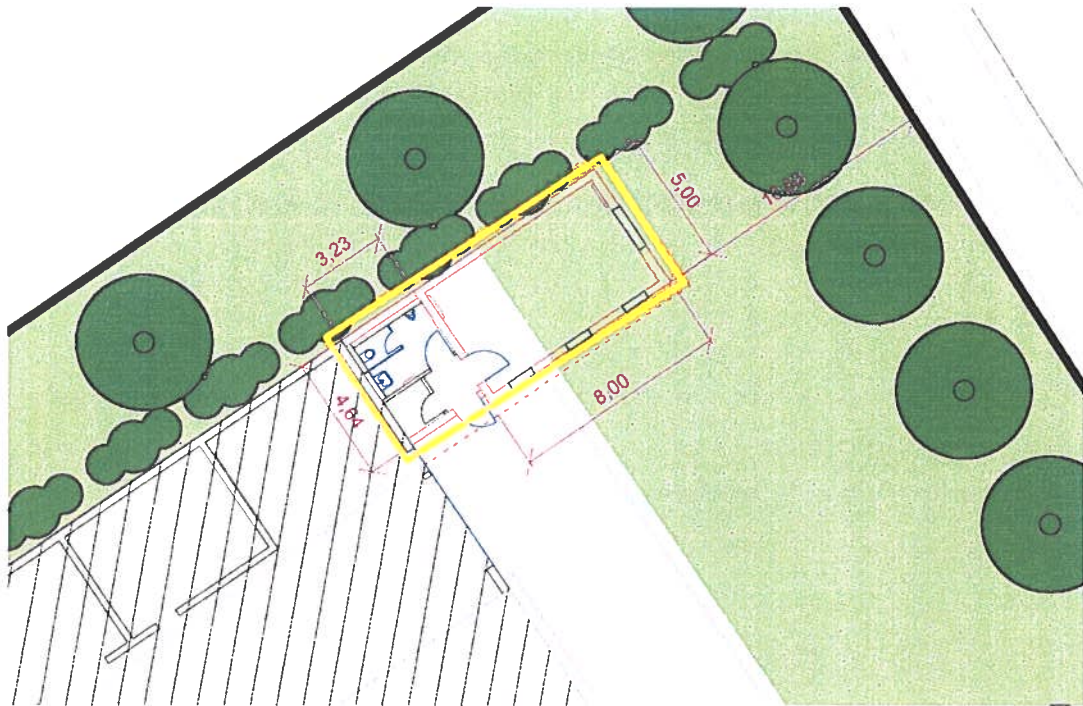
Geplanter Anbau (gelbe Umrandung) an das bestehende Vereinsgebäude, o.M. (Quelle: Ortsgemeinde Irsch).
